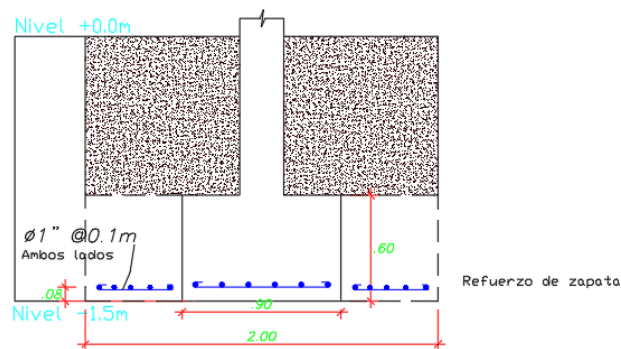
Zapata aislada y reforzada de las columnas adyacentes al BRB.
